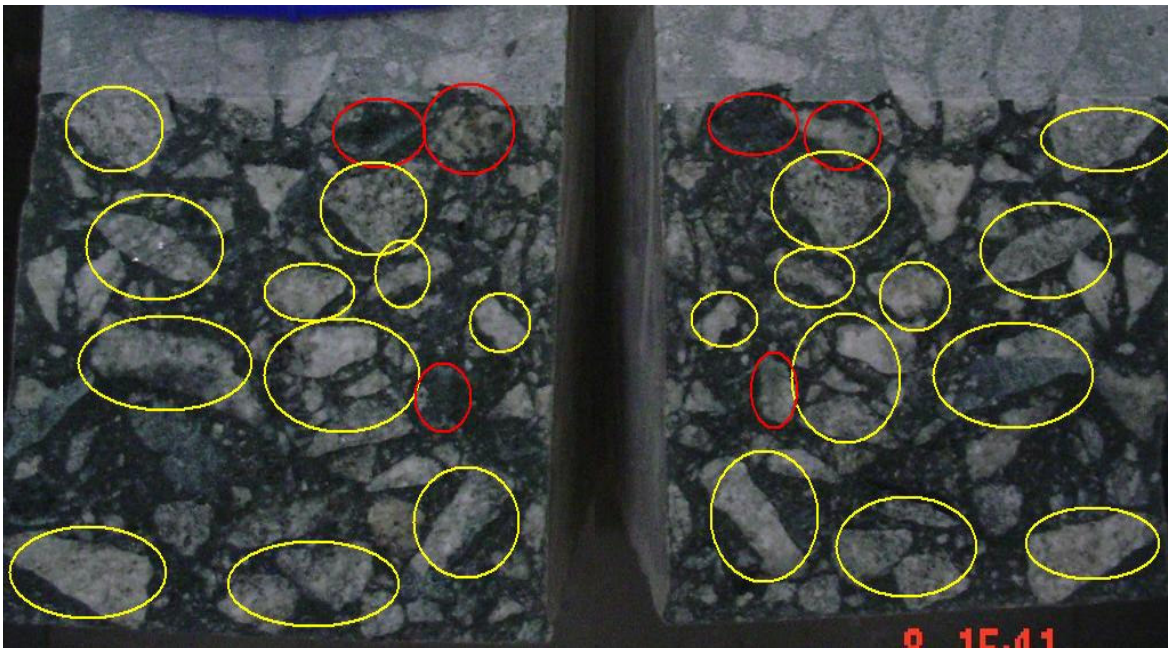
Superfície da viga M32 após a sua ruptura, concreto tipo C.
